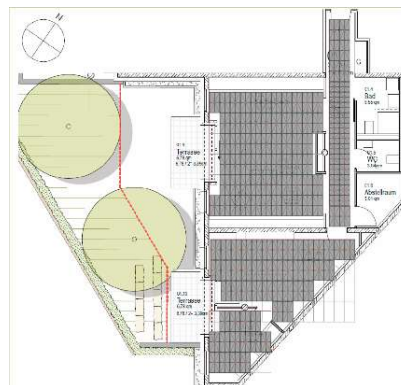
Plan de sol avec SensFloor intégré (exemple)
